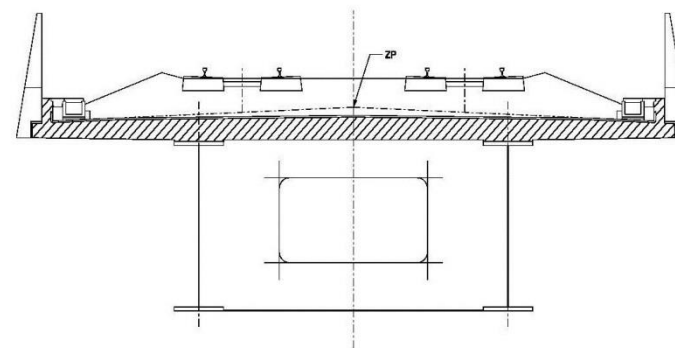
Coupe - Bipoutre mixte (source : INGEROP)
